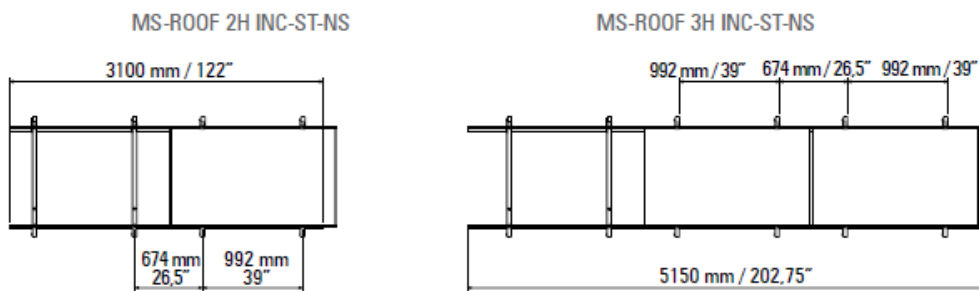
Esquema soporte MS-ROOF 3H INC-ST-NC
